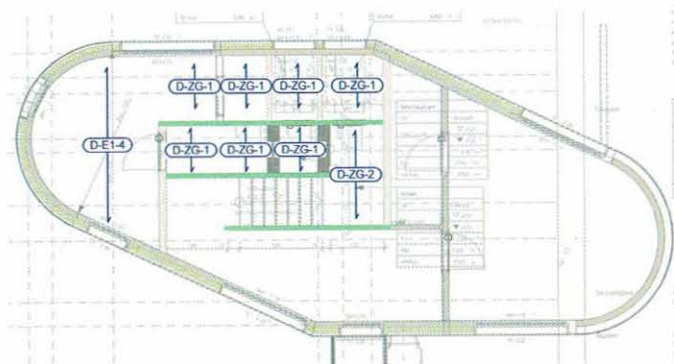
Grundriss 2. Obergeschoss mit den drei Wandscheiben, die das Treppenhaus bilden (grün), und der Außenwand. Treppenstufen und Kabinenböden wurden zwischen diesen Längswänden eingehängt und mit ihnen verschraubt.
